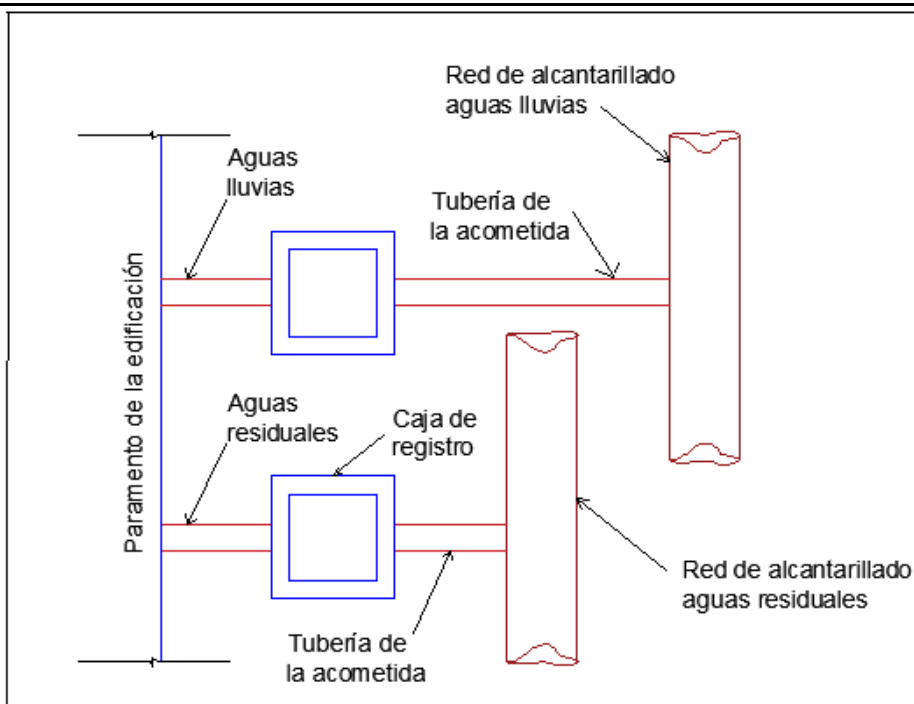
Conexión de acometidas a redes separadas de alcantarillado (vista en planta)
